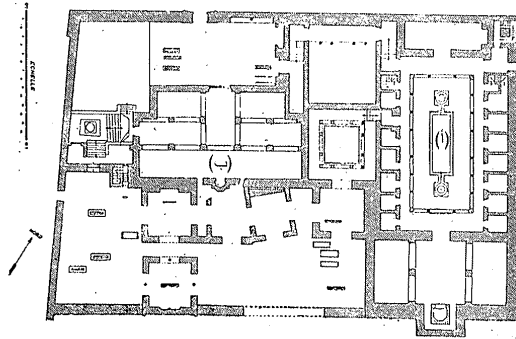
مسقط أفقي لمدرسة سيدي بو مدين المربعية
